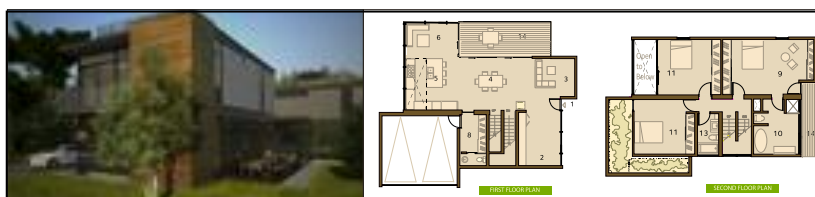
Living Home – RK6.2 – volume e planta baixa do térreo e do segundo pavimento (<http://www.livinghomes.net>)
